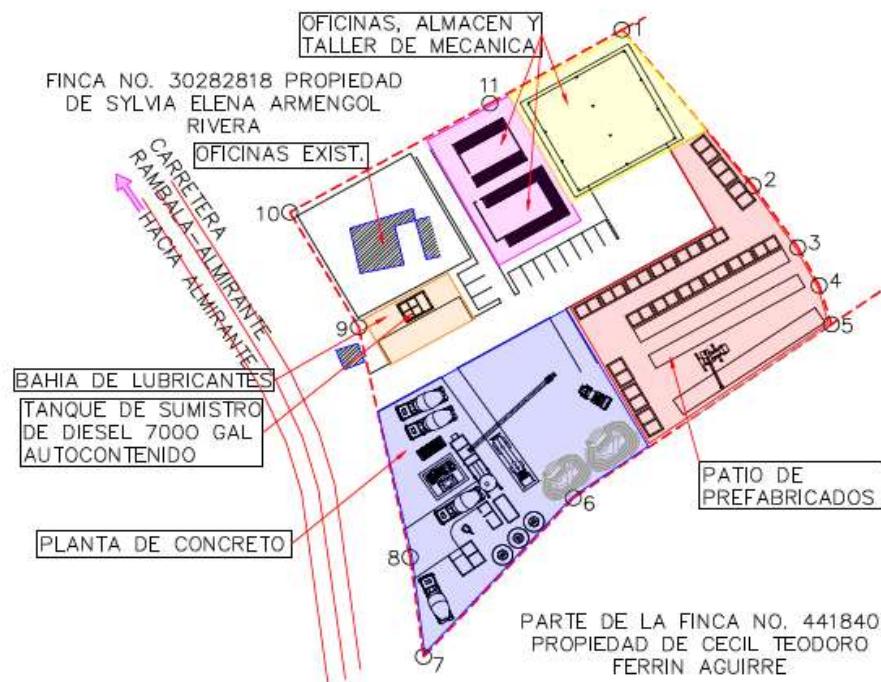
Planta central patio de oficinas, talleres, planta de concreto y patio de prefabricados. Fuente: Empresa promotora.
